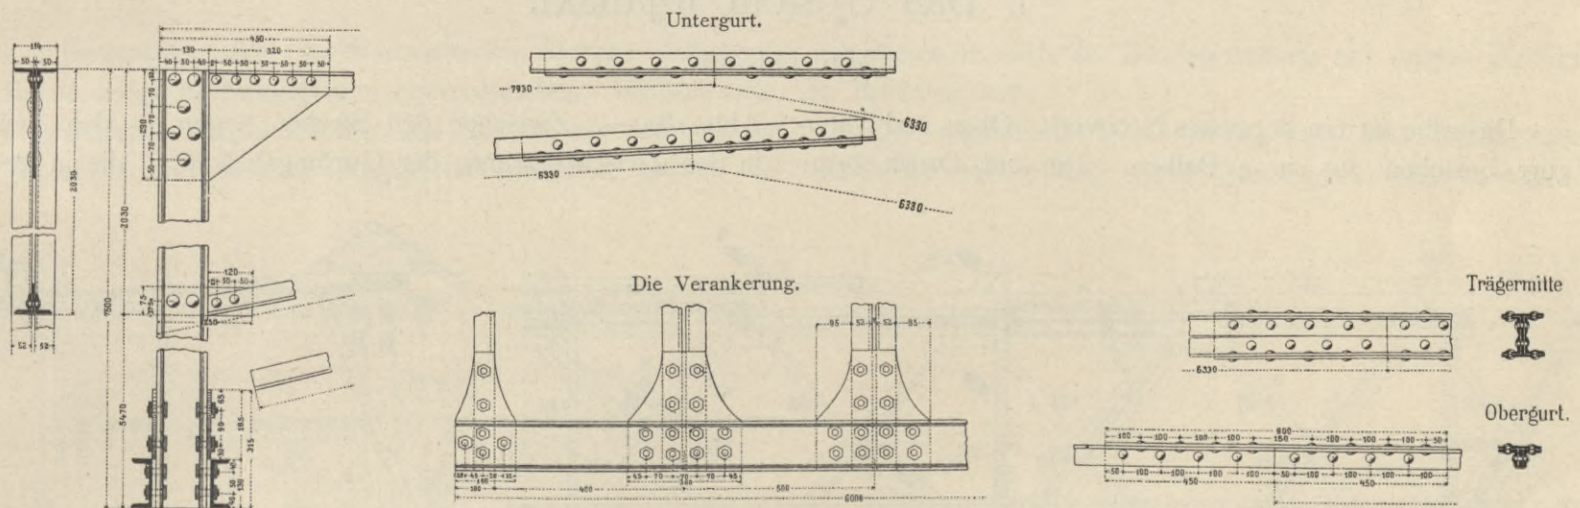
Einzelheiten der Eisenkonstruktion. 1 : 20.
